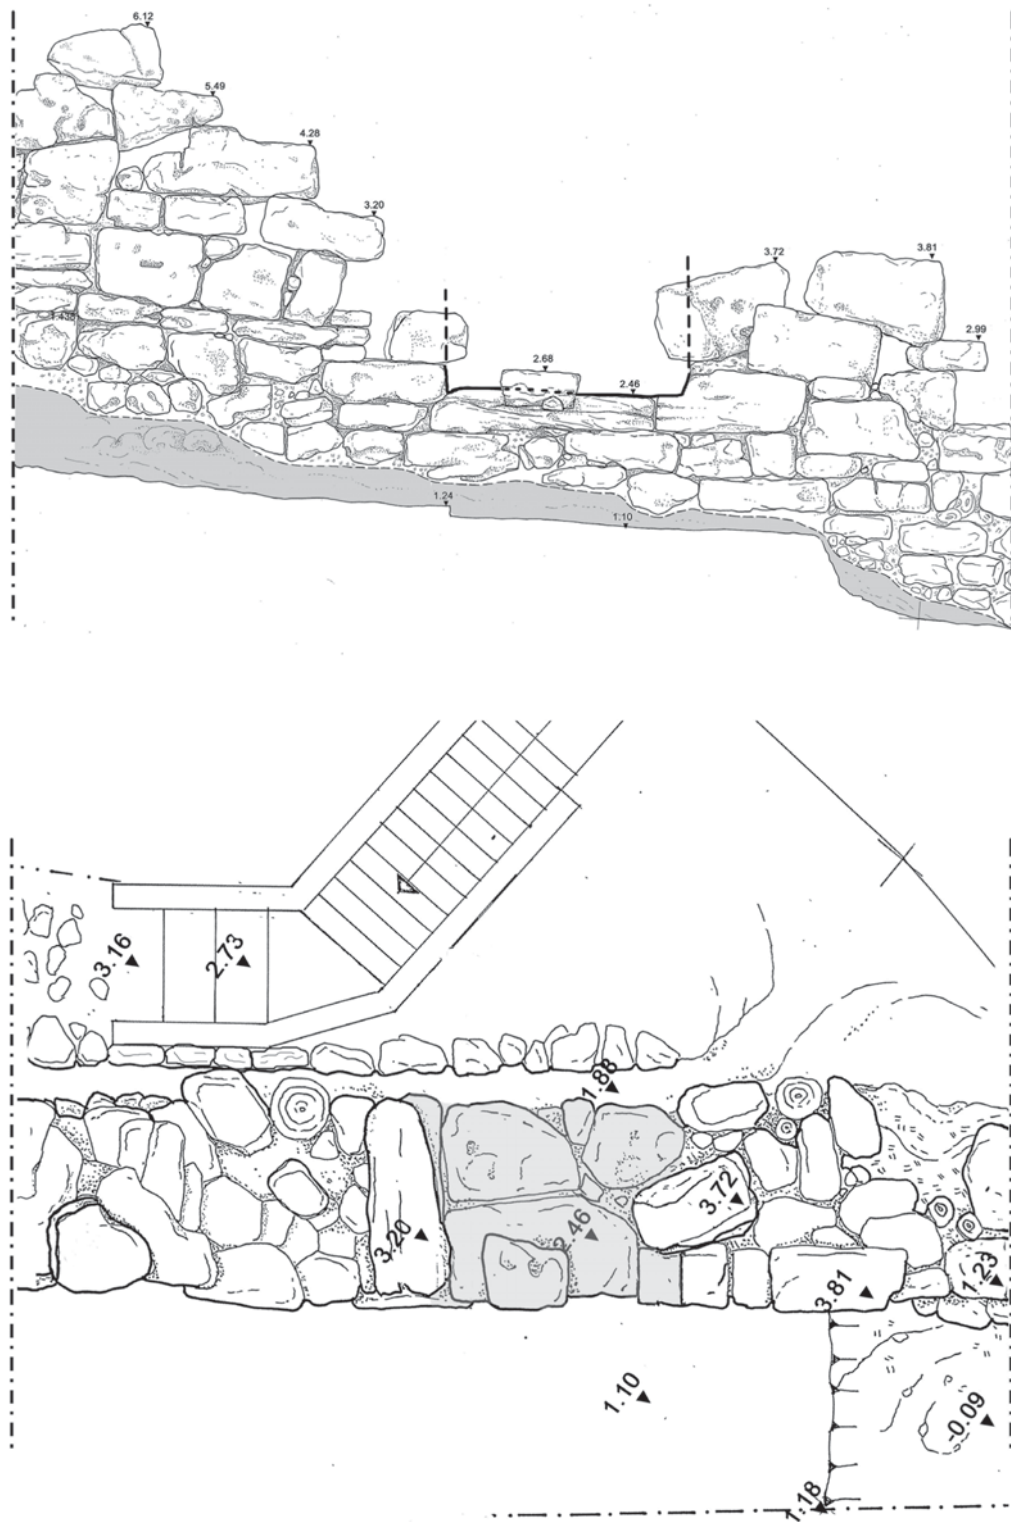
S. Andrea - pianta e prospetto della postierla.
